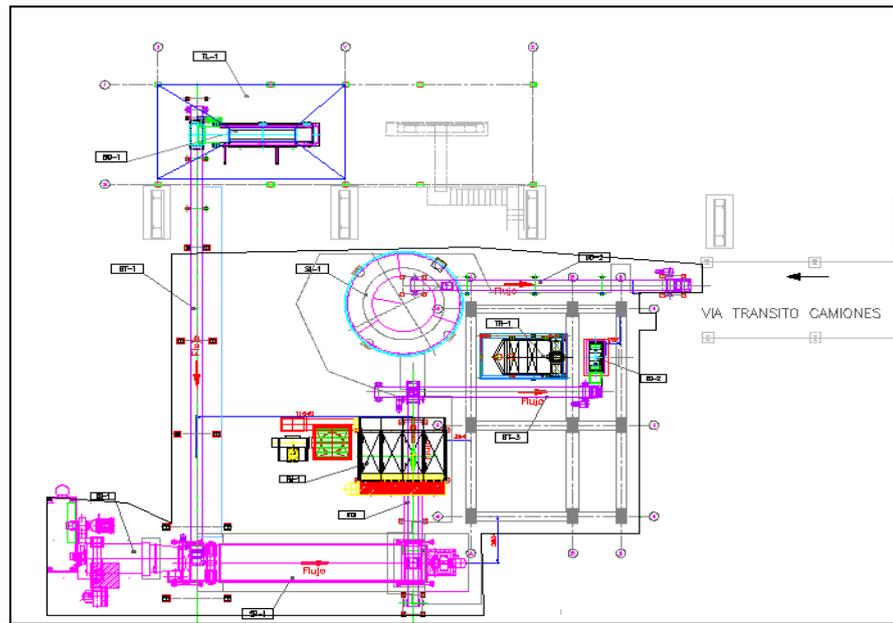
LAYOUT DE LA PLANTA DE SECADO Y MOLIENDA.¹
